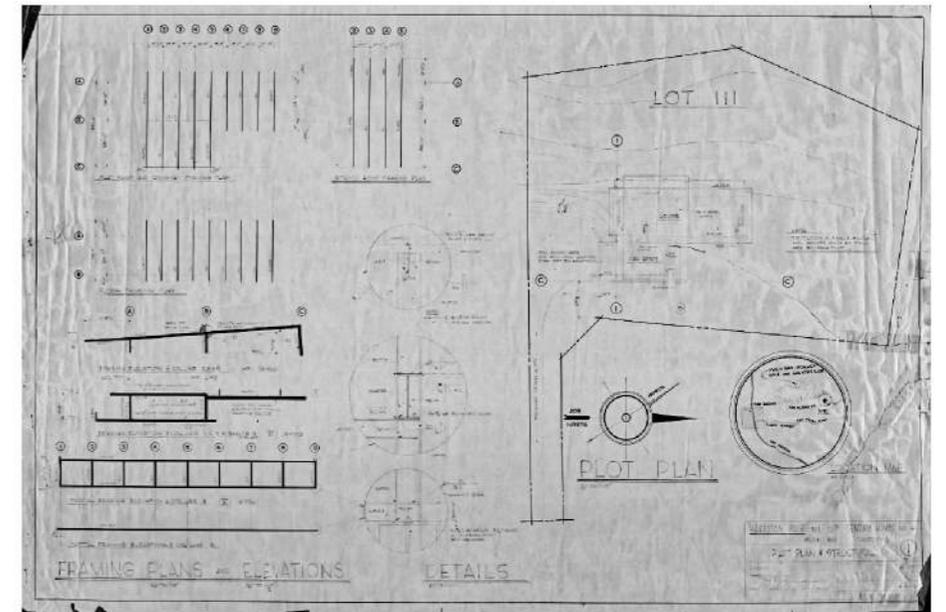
CSH-6 Plano con detalles y especificaciones técnicas para la prefabricación del sistema amporticado en estructura metálica, las mismas que se instalan en sitio.
